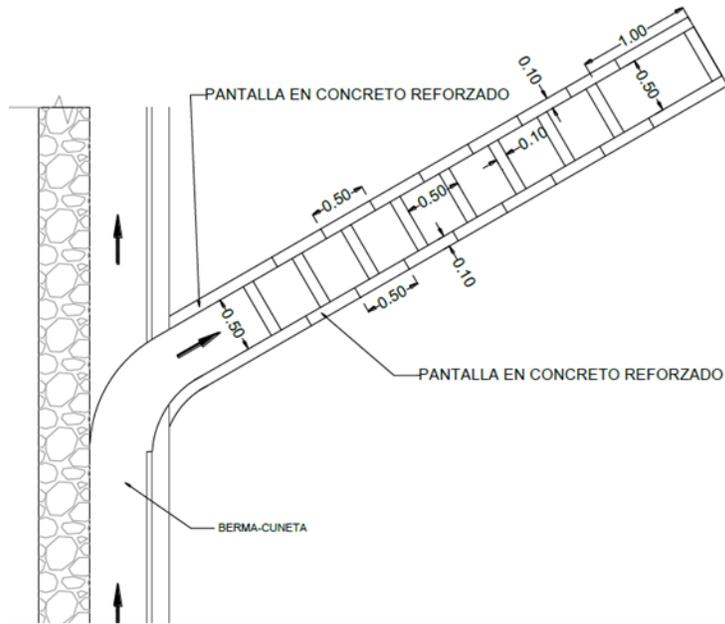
Disipador de energía de tipo rápidas escalonada en planta (Fuente: Guía de diseño de pavimentos de placa huella INVIAS)
